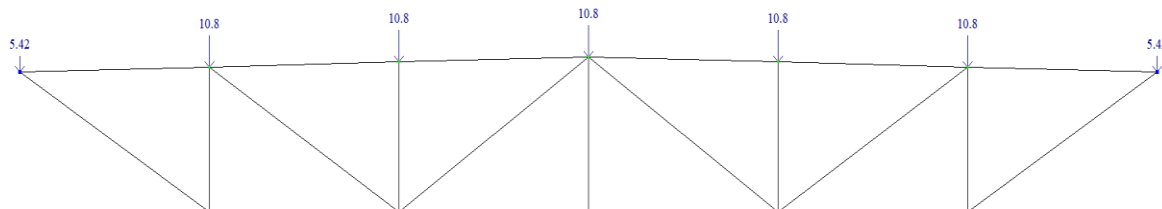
Загрузка 2: нагрузка от веса покрытия
